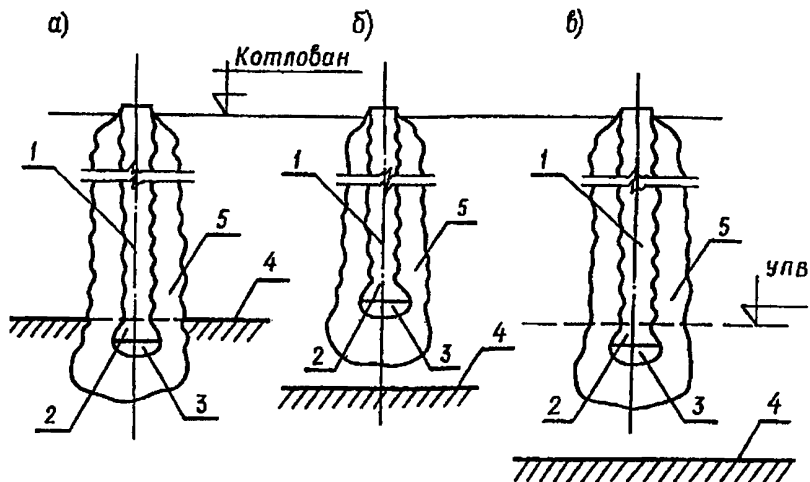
Набивные сваи в пробивных скважинах при опирании в несущий слой (а), при армировании массива (б) и при обводненном основании (в): 1 - ствол сваи; 2 - опорная плита; 3 - уплотненное грунтовое ядро; 4 - несущий слой; 5 - уплотненная зона грунта (рубашка)
